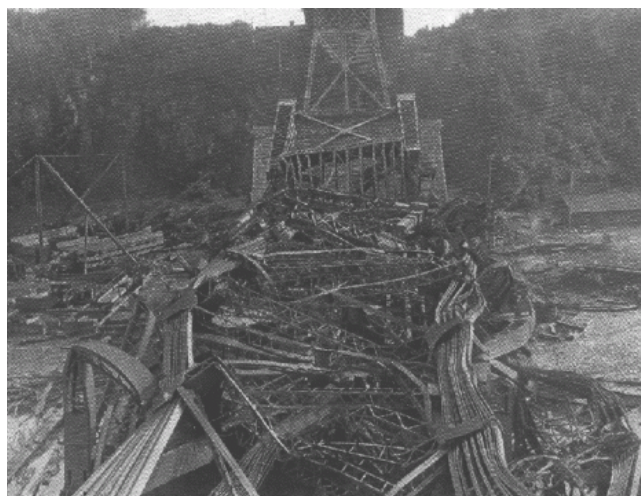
Queda da estrutura em treliça da Ponte sobre o rio St. Lawrence
